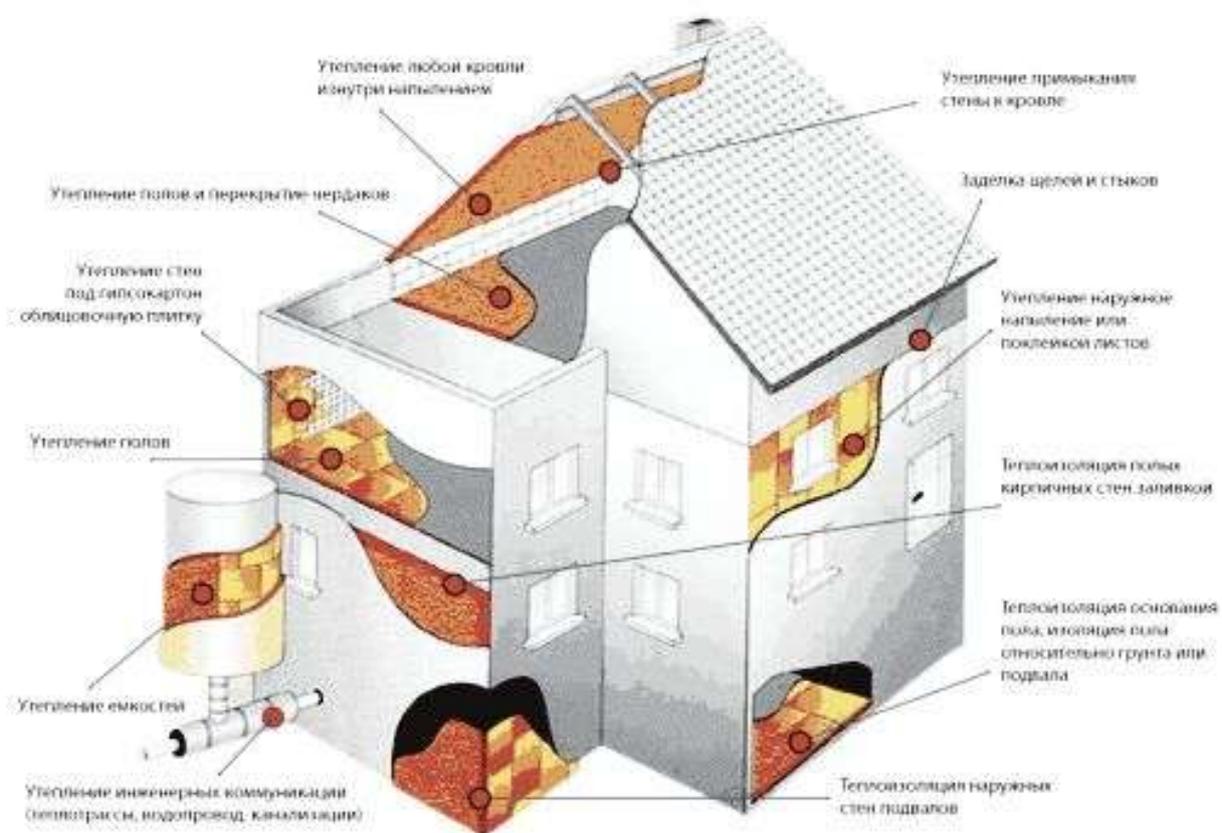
Схемы утепления строительных конструкций и инженерного оборудования
